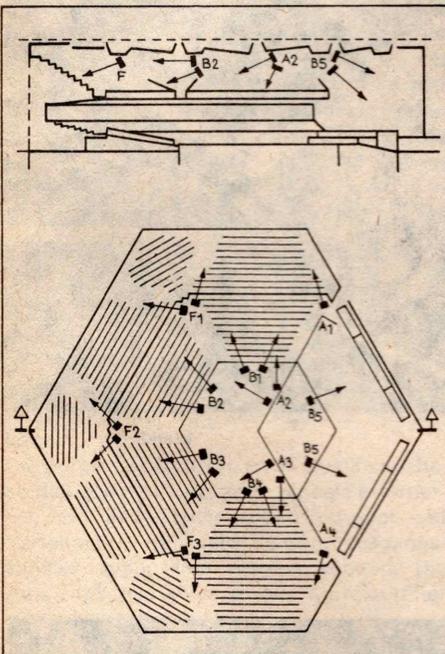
Grundriß und Schnitt für eine Variante des Großen Saales im Palast der Republik. Anordnung der Lautsprechergruppen A, B, F
